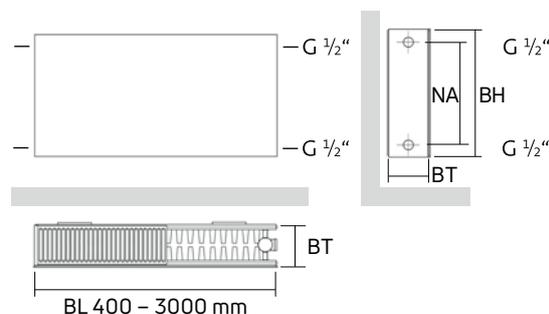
Plan Compact 4-Muffen-Planheizkörper
